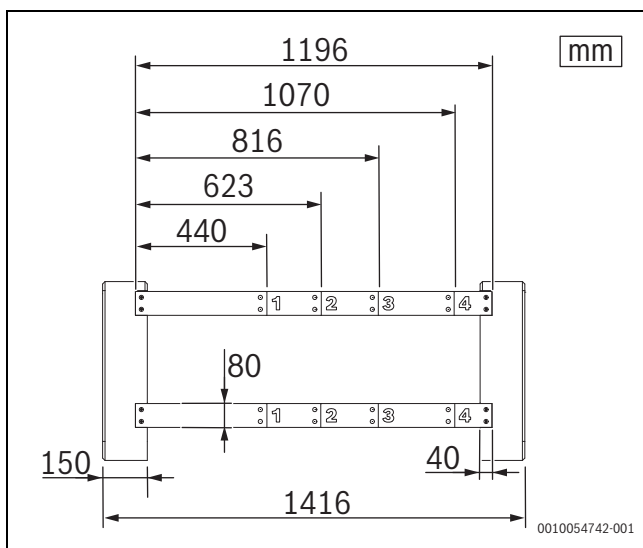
Dimensioni fondazione prefabbricata (assemblata)
